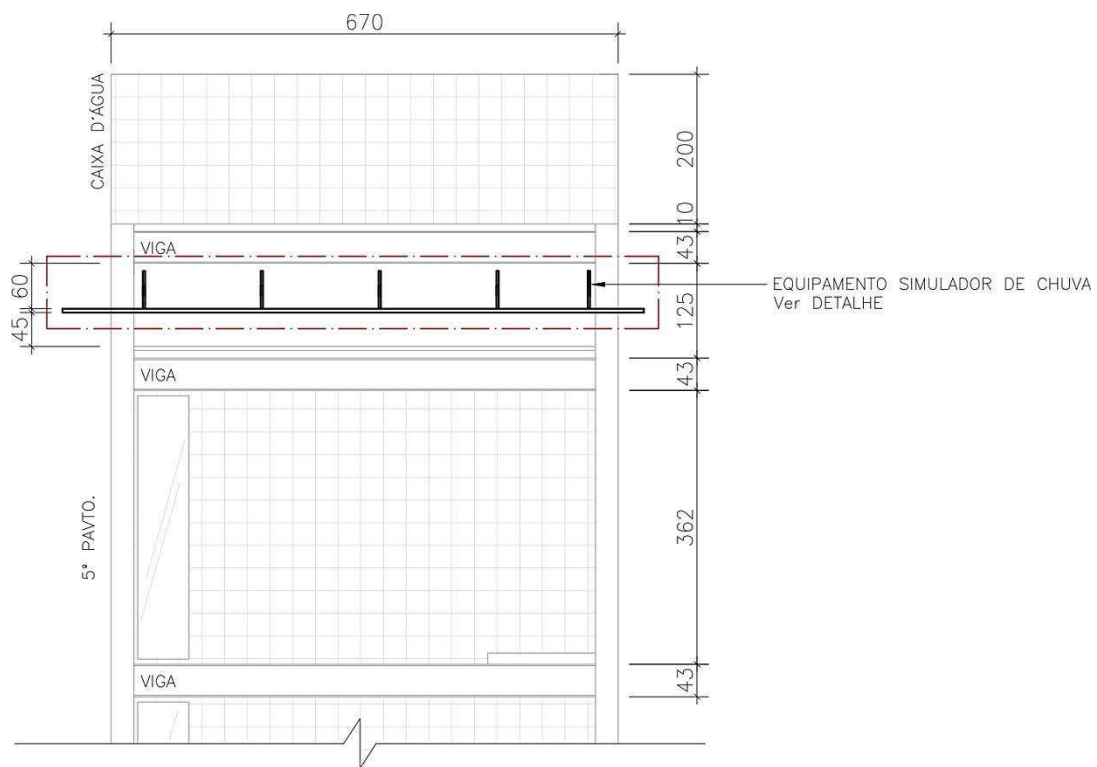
Vista frontal da fachada com a posição do dispositivo.
